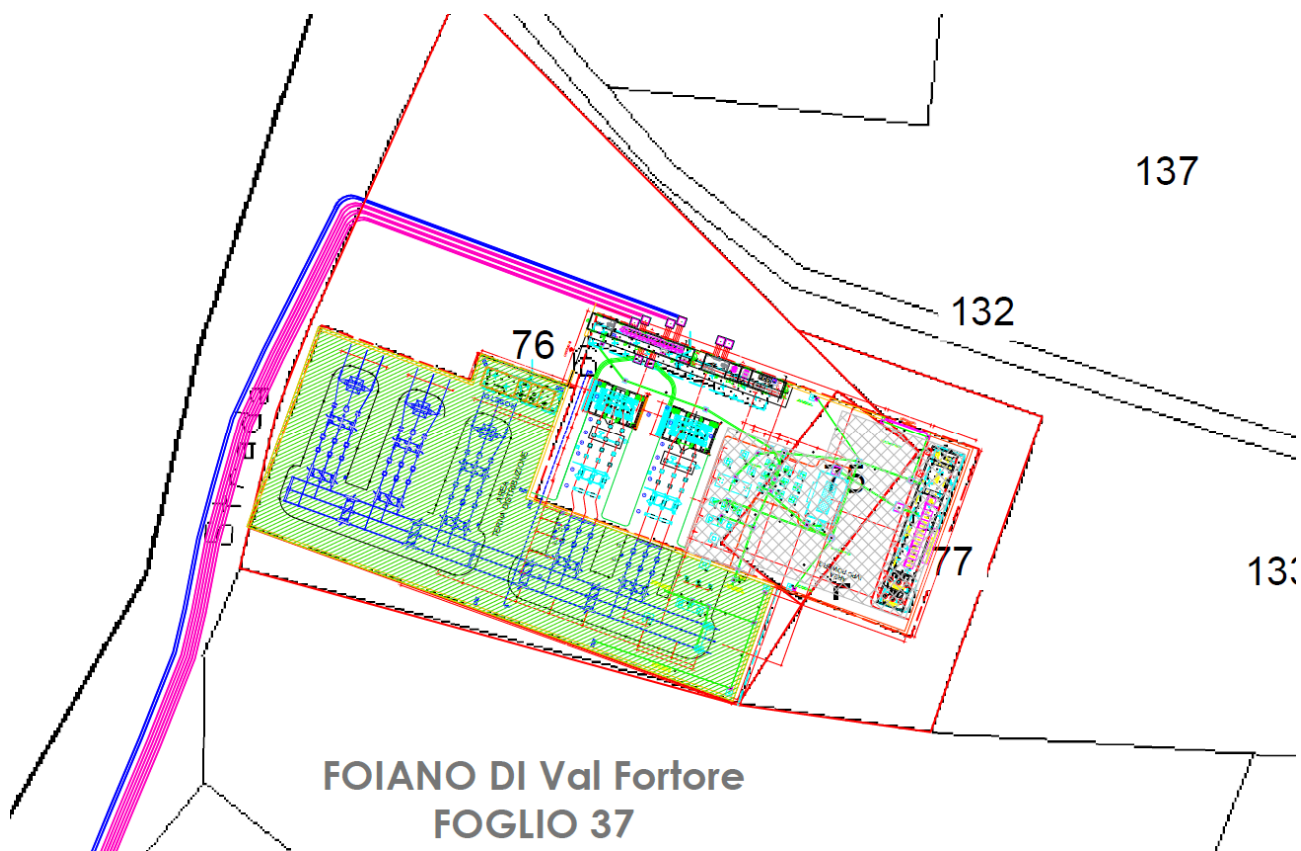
Planimetria su catastale dell'area di intervento: campite con retino grigio, le aree non oggetto di intervento; in blu e viola l'elettrodotto MT 30kV; con retino verde, la Stazione Terna
